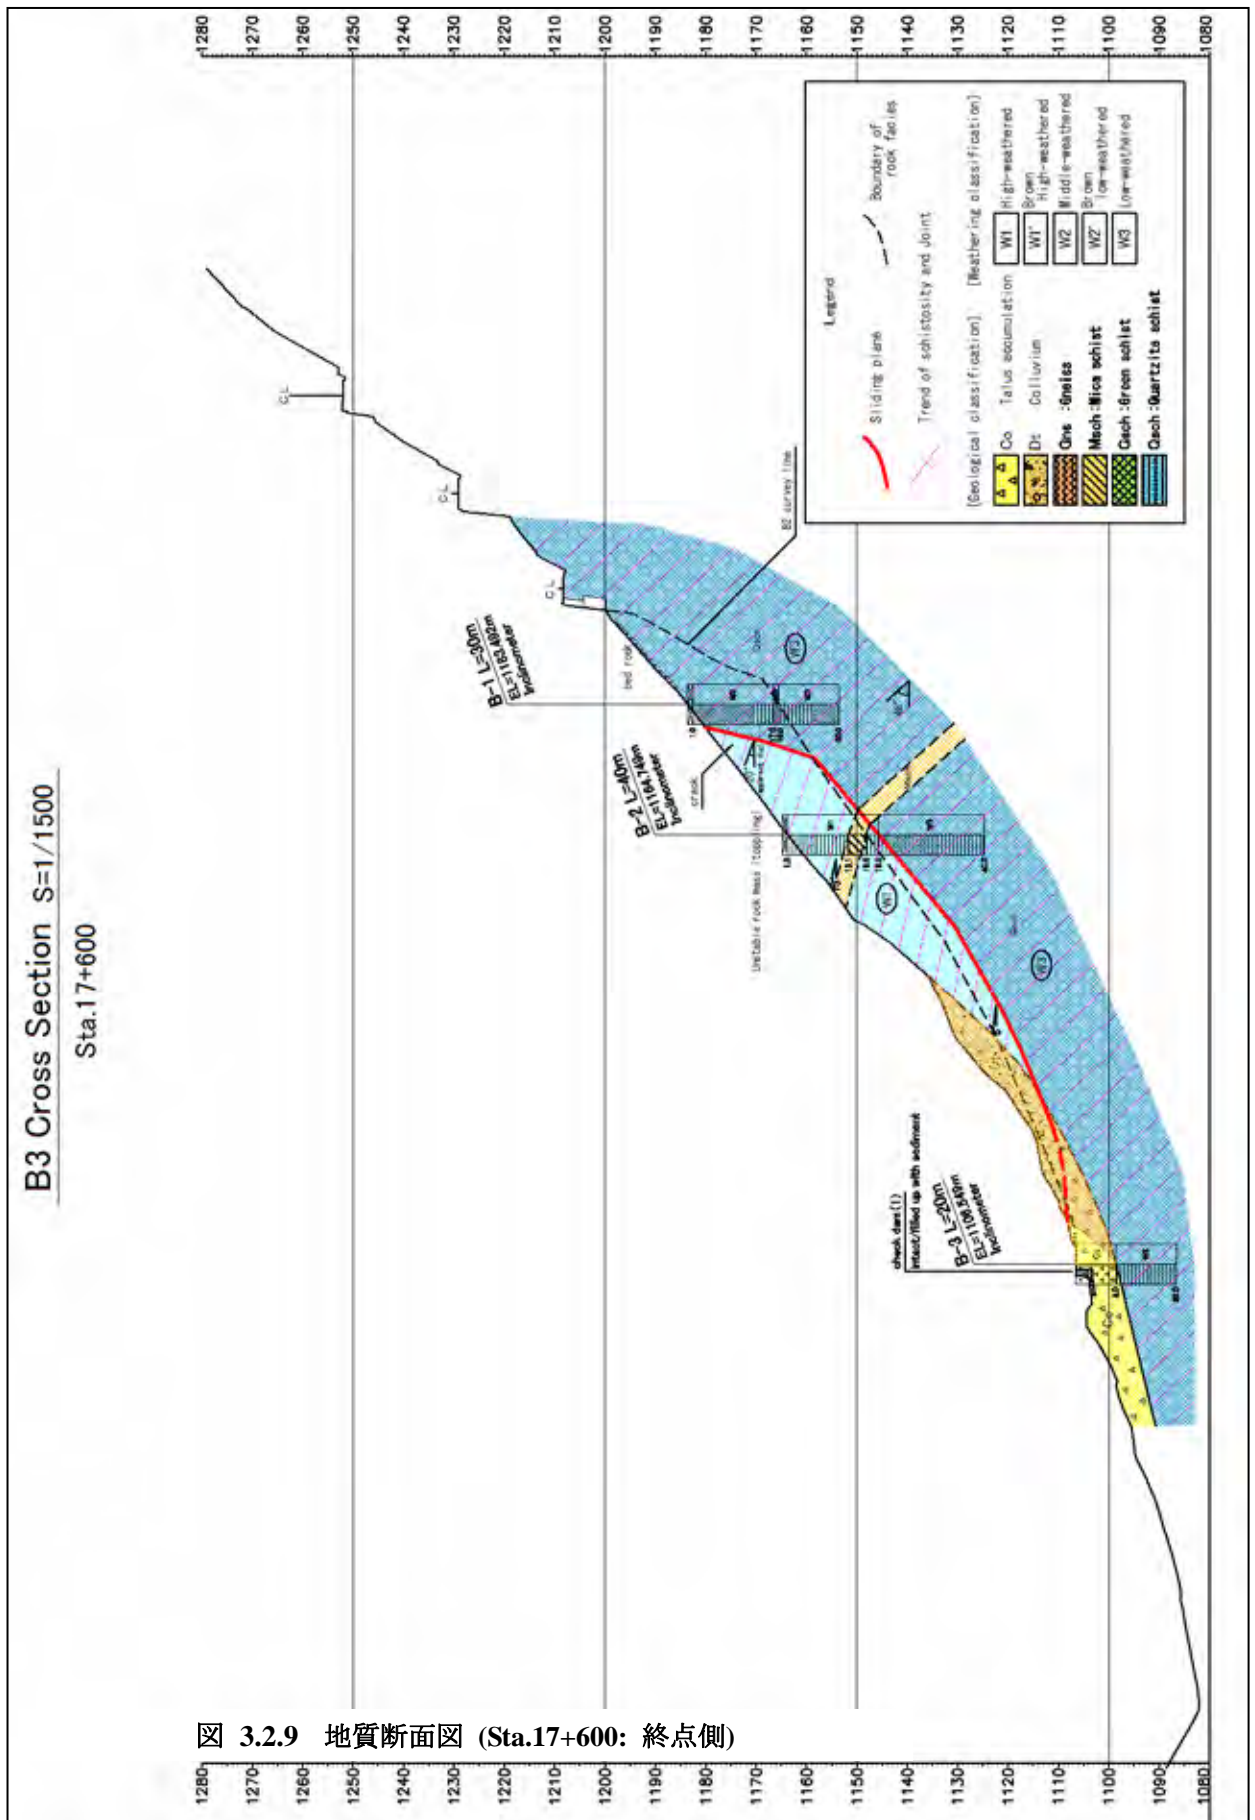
地質断面図 (Sta.17+600: 終点側)
